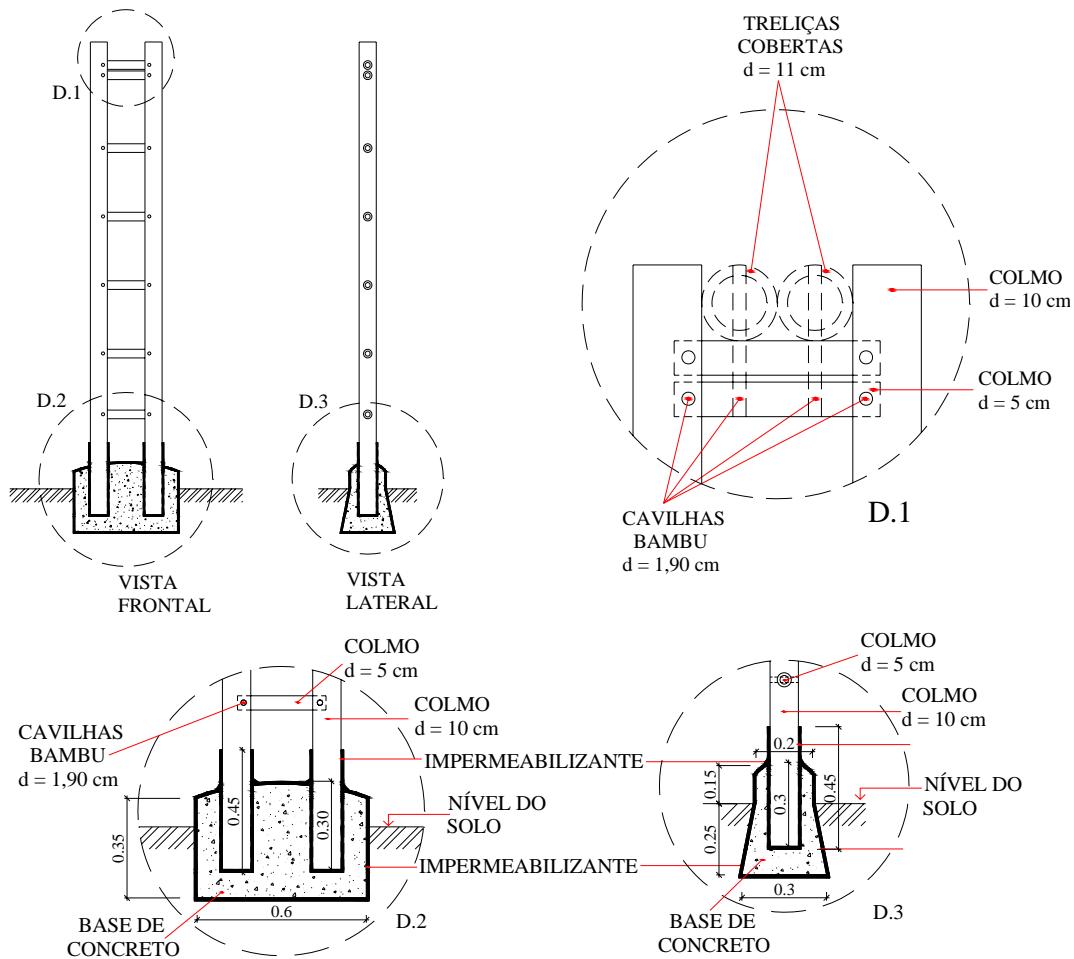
Concepção do pilar - Modelo PL01 (vistas frontal e lateral, e detalhes).
